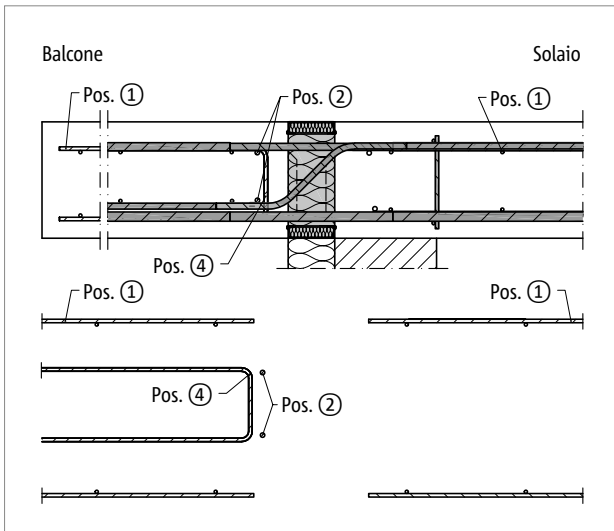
Schöck Isokorb® T tipo K-M13 – M14: armatura in opera con appoggio diretto
